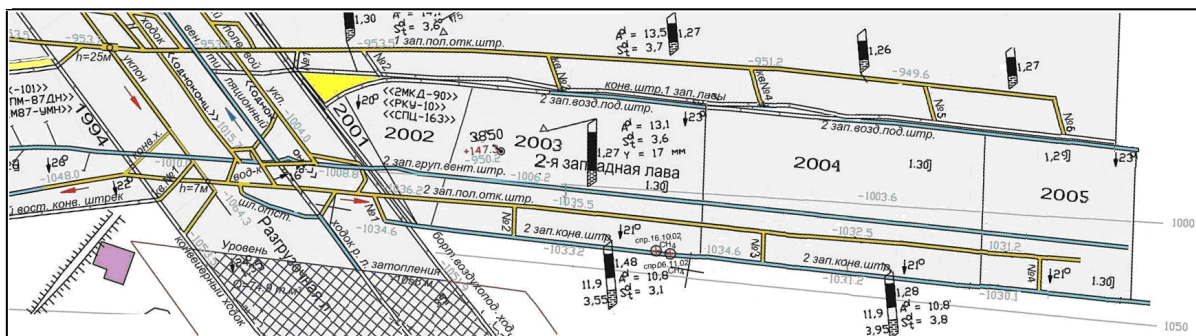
Схема расположения 2-й западной лавы пласта  $h_{10}$  на плане горных выработок
